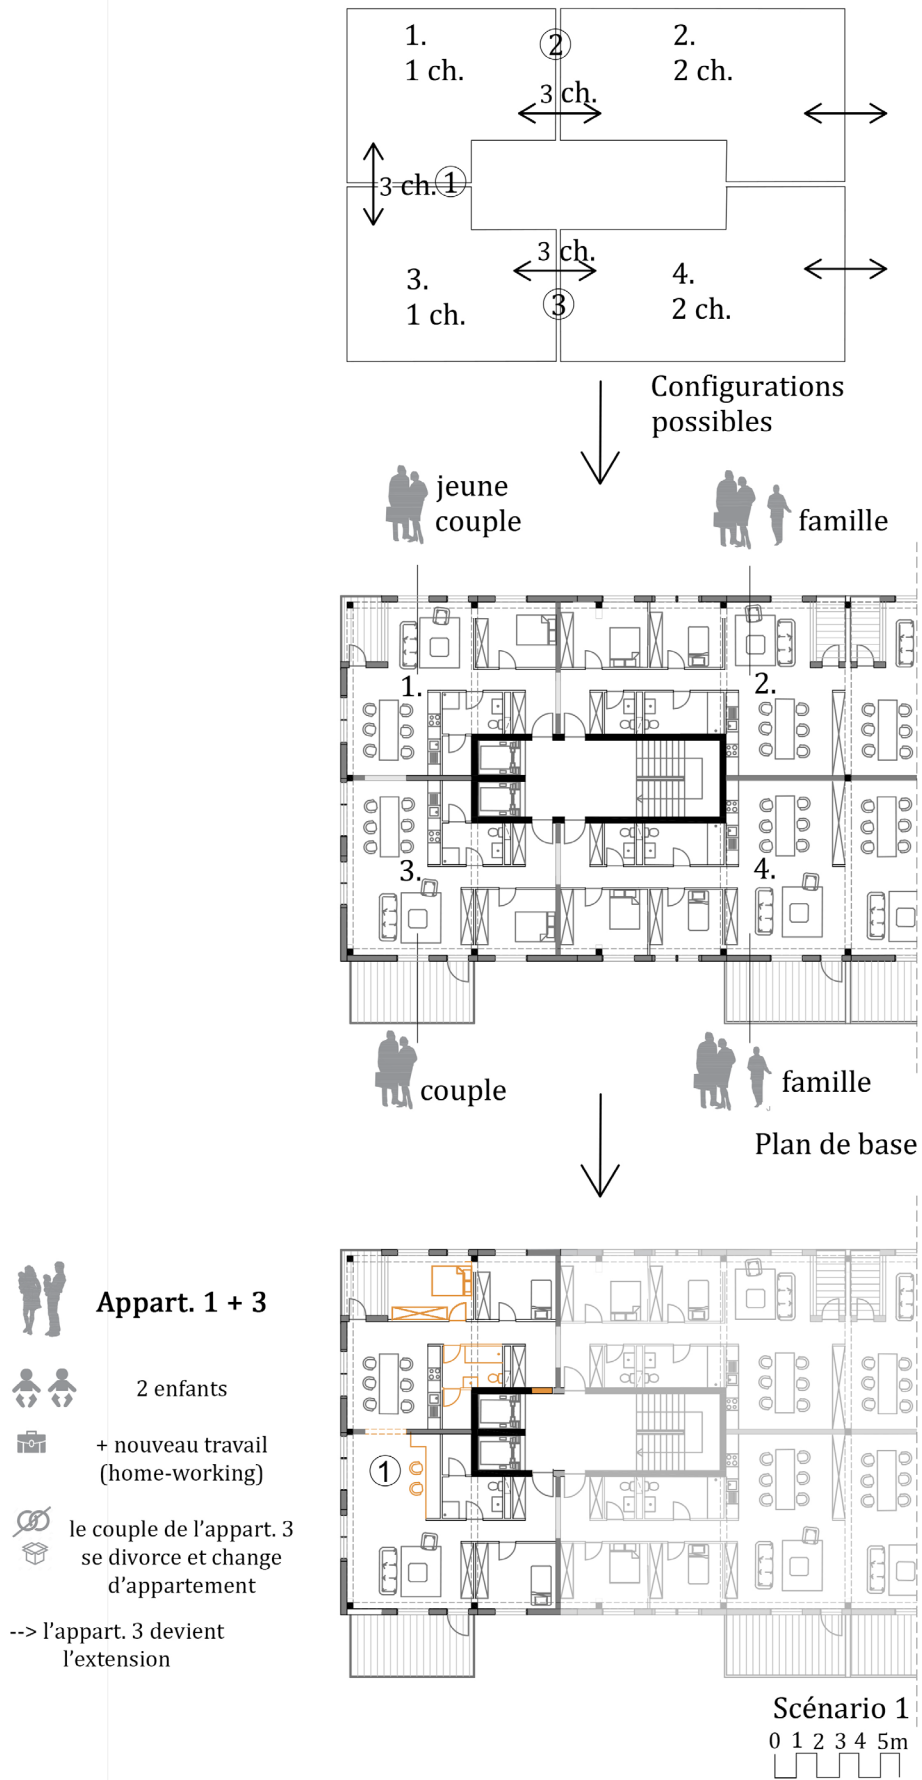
Plans d'adaptabilité logements – petit noyau
